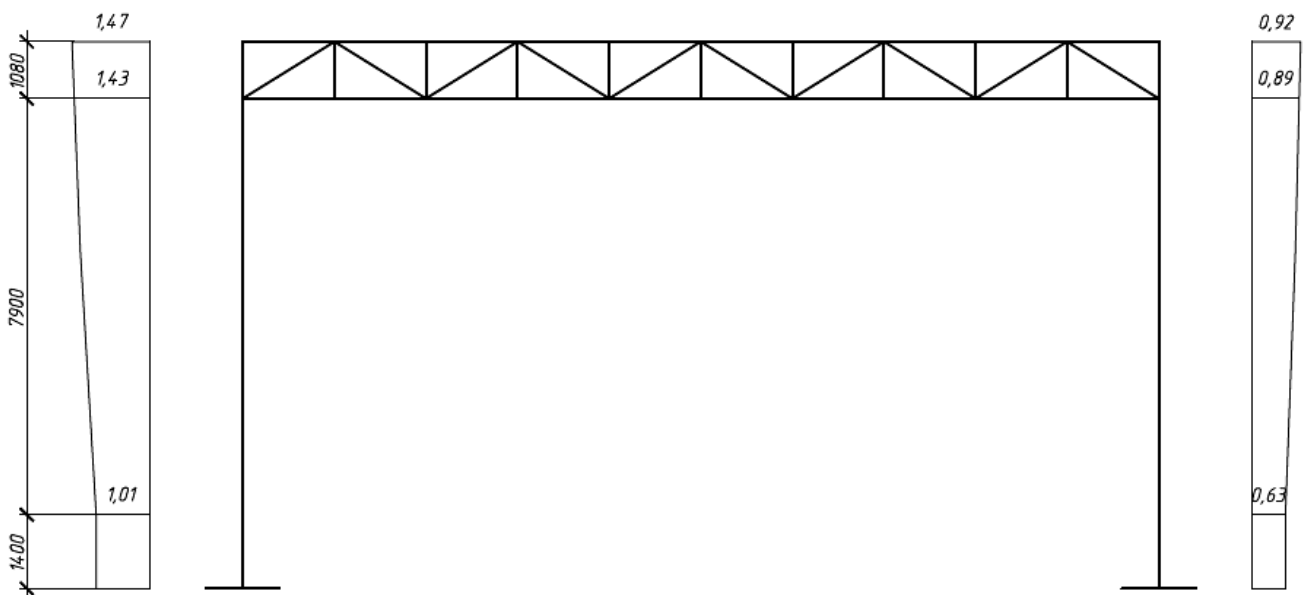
Схема распределения ветровой нагрузки по высоте здания
